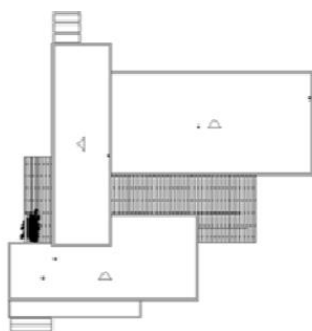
Planta da cobertura, (Metalusa, 2015)
